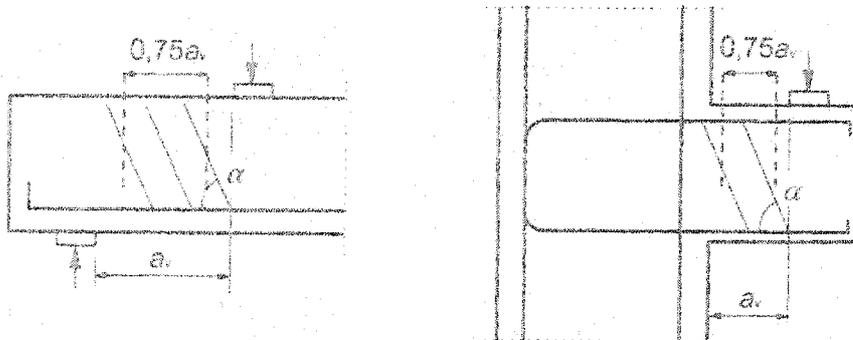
Bereich zur Berücksichtigung der Querbewehrung im Fall einer auflagernahen Einzellast gemäß EN 1992-1-1
